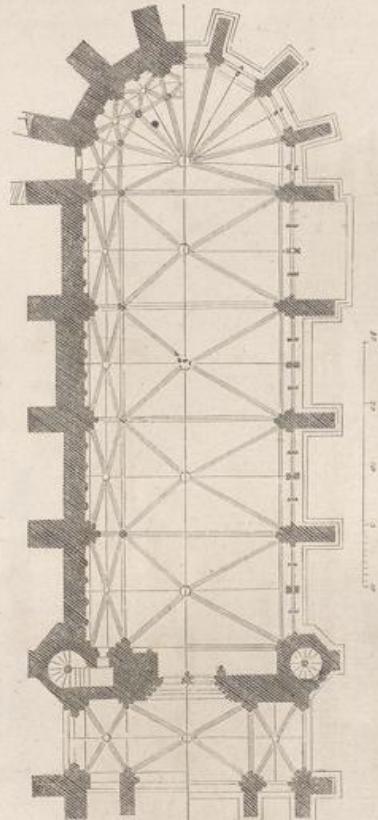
Ste. Chapelle zu Paris. Grundriss.
